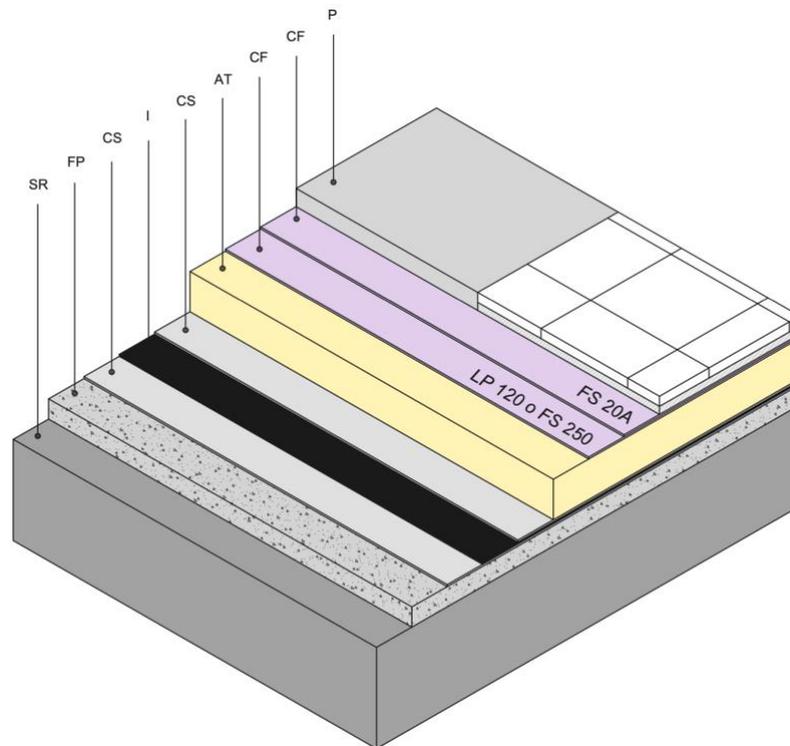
Posición capa filtrante en cubierta invertida (C). Leyenda: SR Soporte resistente. FP Formación de pendiente. CS Capa separadora. I Impermeabilización. AT Aislante térmico. CF Capa filtrante. P Protección (hormigón o pavimento cerámico).
